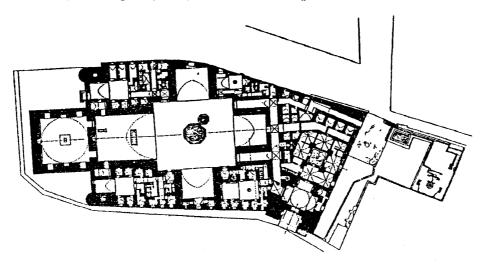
مسقط أفقي لمجمع السلطان قلاوون بالقاهرة . (عن : Creswell) .
